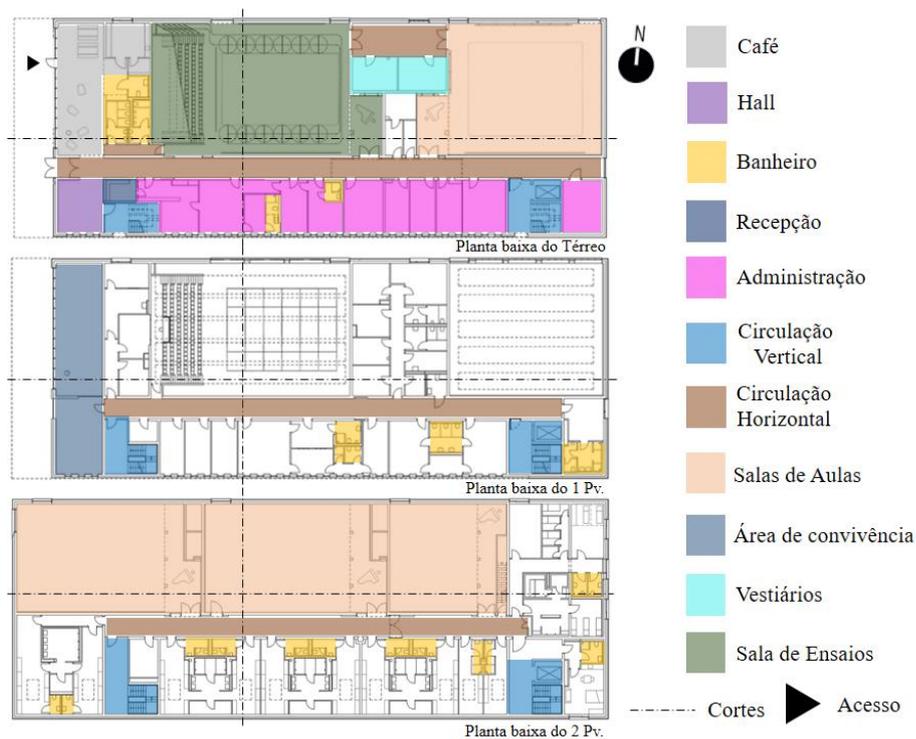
Setorização das Plantas Baixas da Escola Ballet am Rhein
